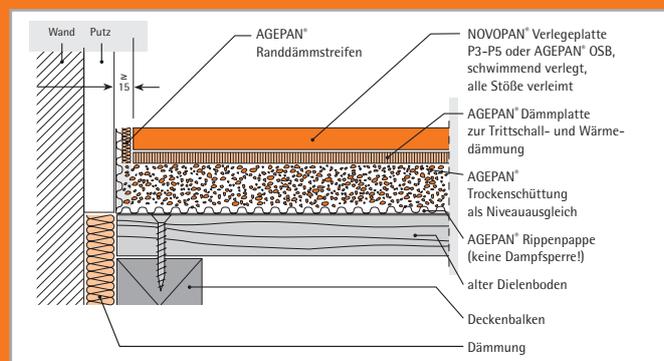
Das schwimmende Verlegen auf Holzbalkendecken mit AGEPAN® Trockenschüttung.
